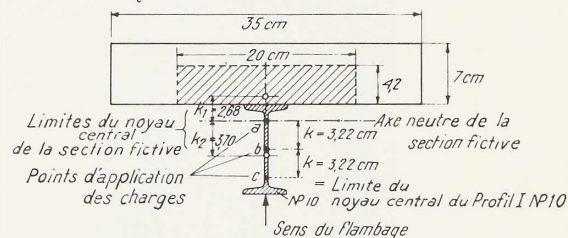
Section d'un poteau, système « Alpha ». Première série d'essais. Application de l'effort sur la poutrelle I PN 10.
